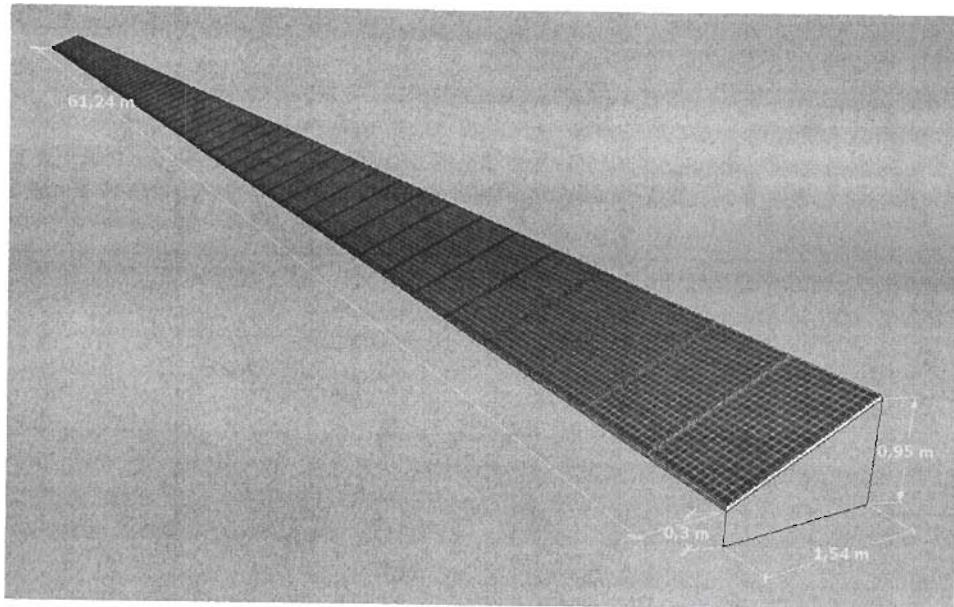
Disposição dos módulos em um arranjo FV do sistema BAPV.
